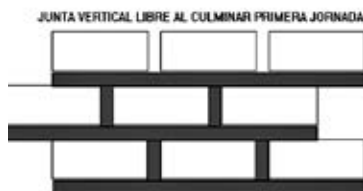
Tratamiento de la junta de construcción entre jornadas de trabajo.
